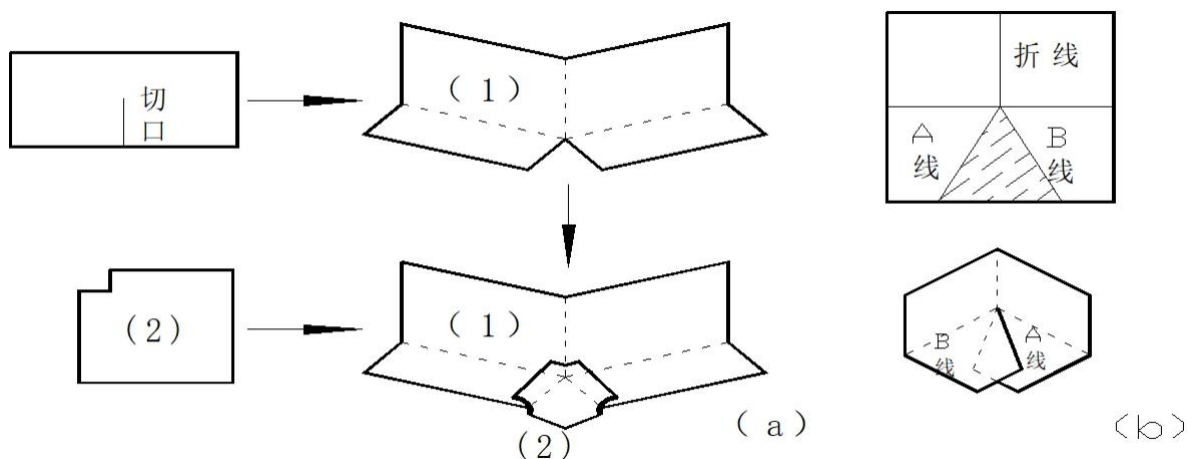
屋面防水阴角及防水收头部位详细做法
